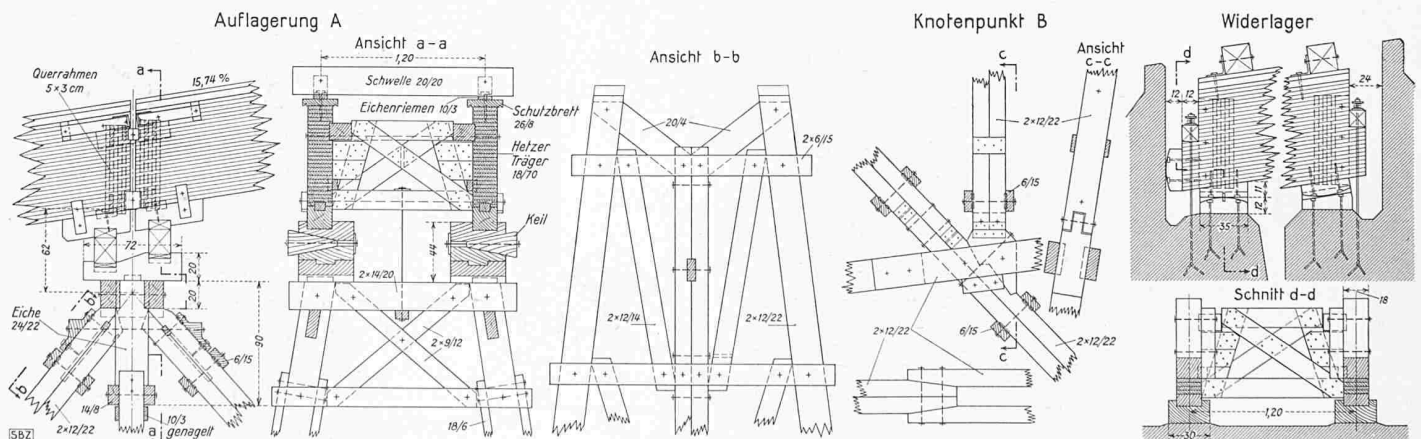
Konstruktive Einzelheiten, Masstab 1:50
